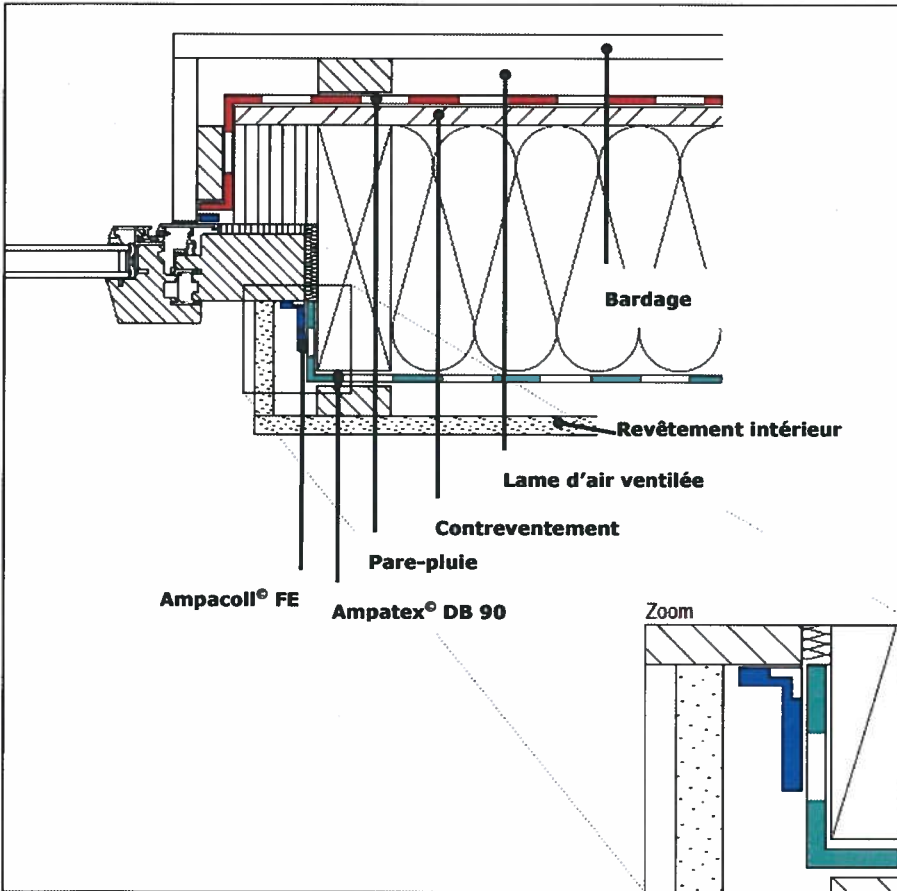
Fenêtre posée en tunnel ou au nu extérieur, coupe horizontale.
